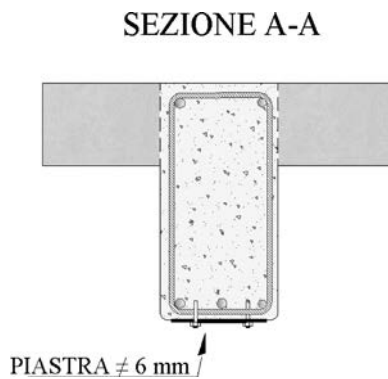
Vista in sezione di cui alla Figura 3.133.
